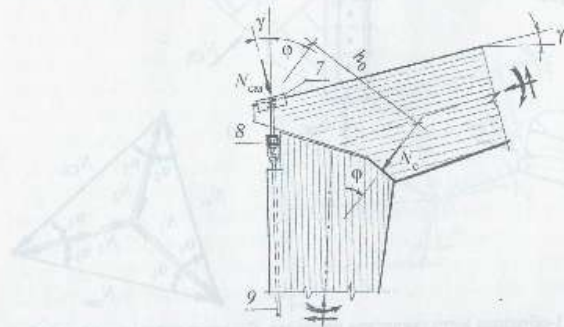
Расчетная схема жесткого узла по рис. 8.2, α
